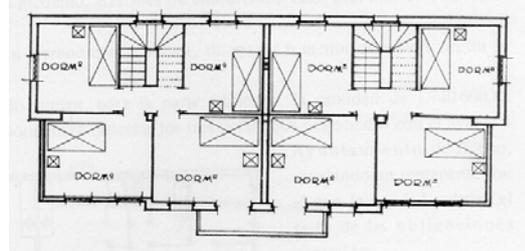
Planta baja del Tipo C de la Ciudad Jardín
